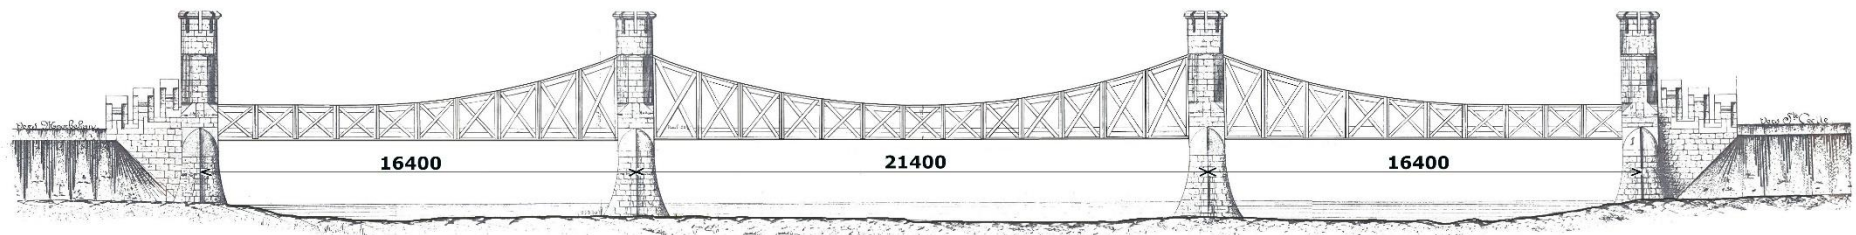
Vue en élévation du pont du Breux original à chasserpierre (Marc Braham ; reconstitution d'après les plans originaux)
